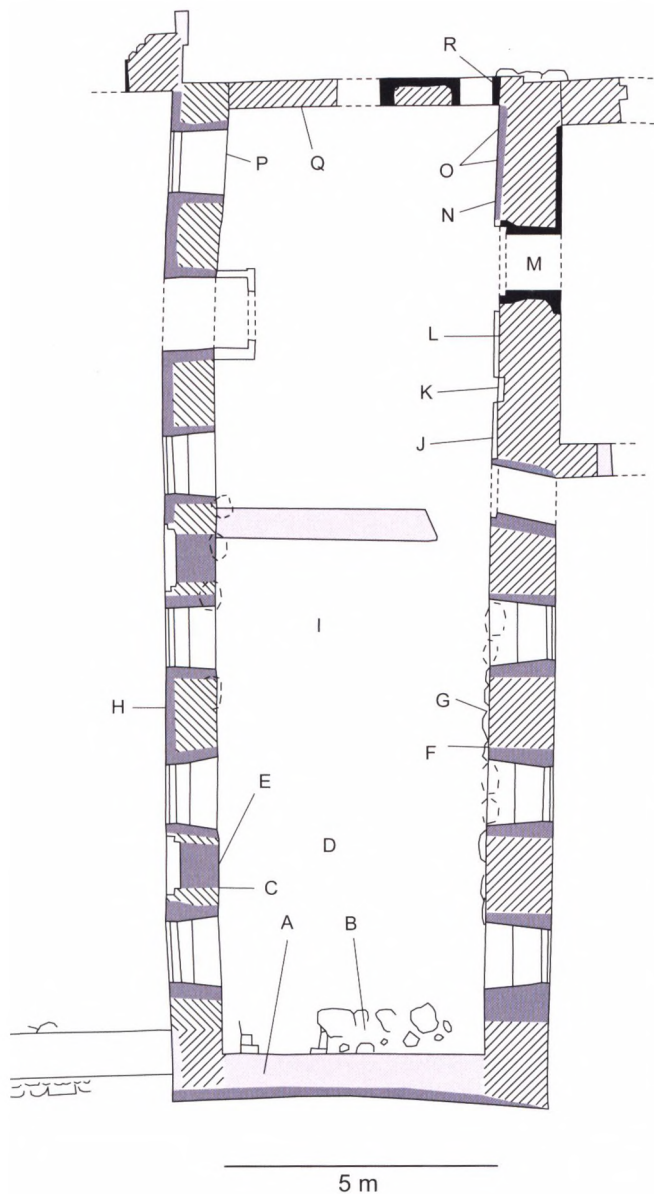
Bygning G, stueplan. A) Bygget hen over gl. murkerne. B) Stræk-
